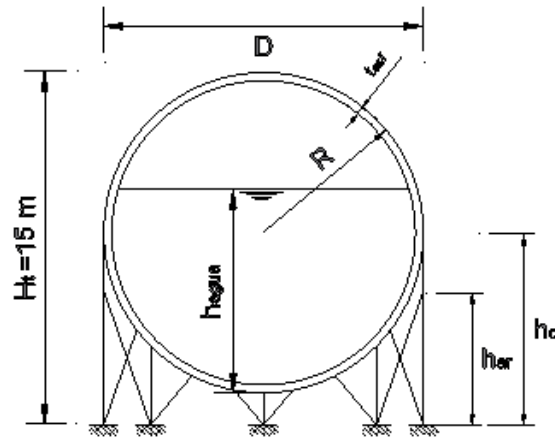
Parámetros estructurales en tanques esféricos elevados
